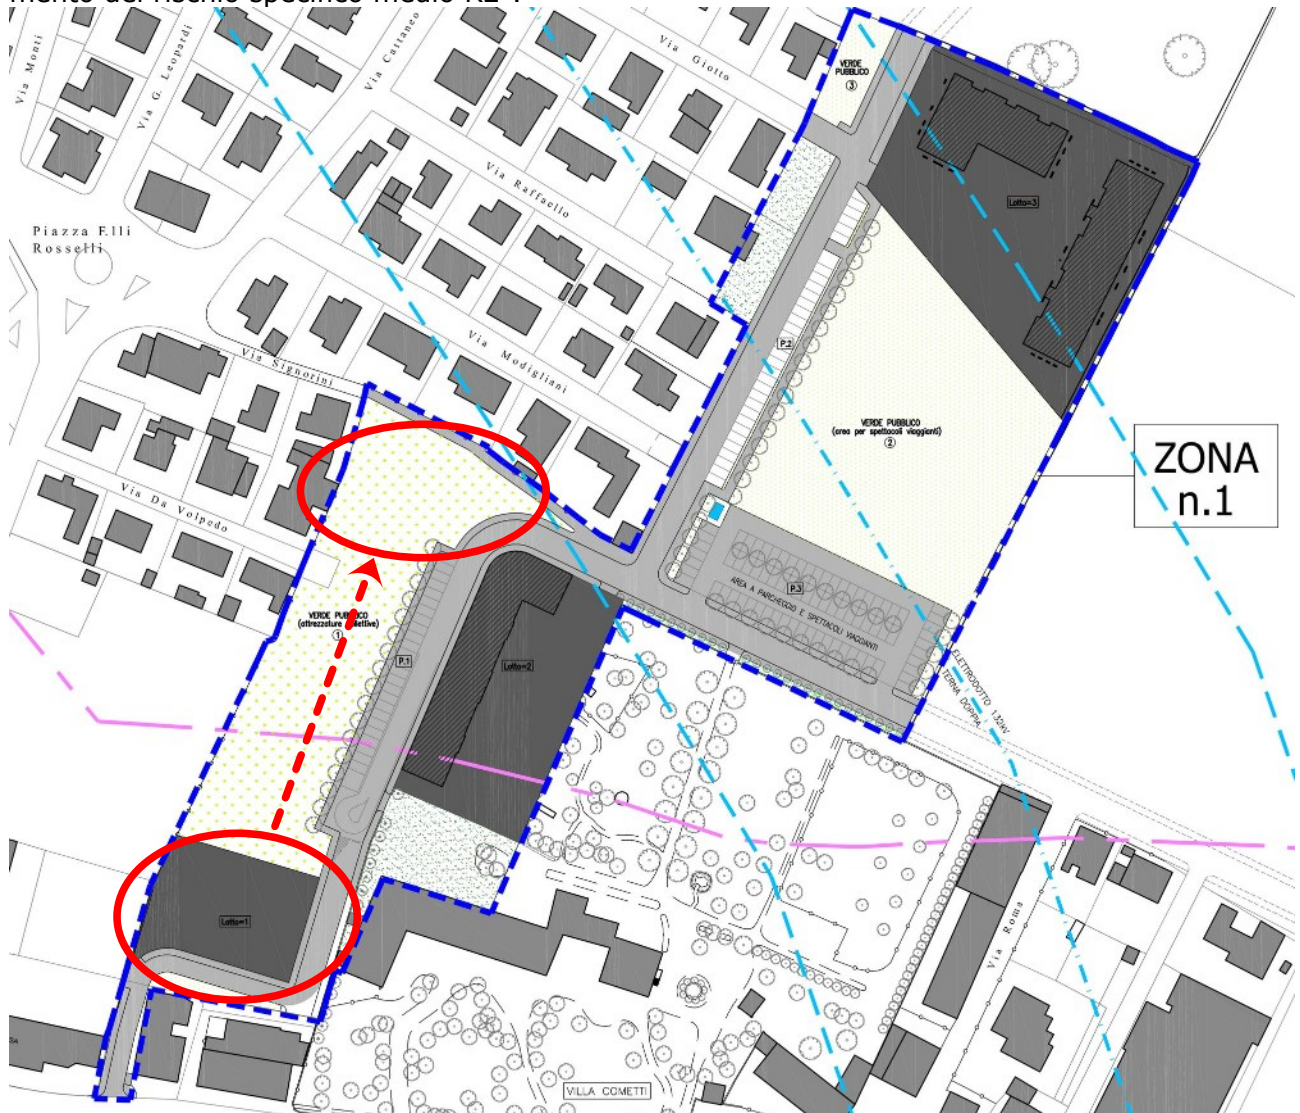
Stralcio "Piano particolareggiato vigente: Planimetria generale d'insieme zone 1 e 2", Tav. 02
